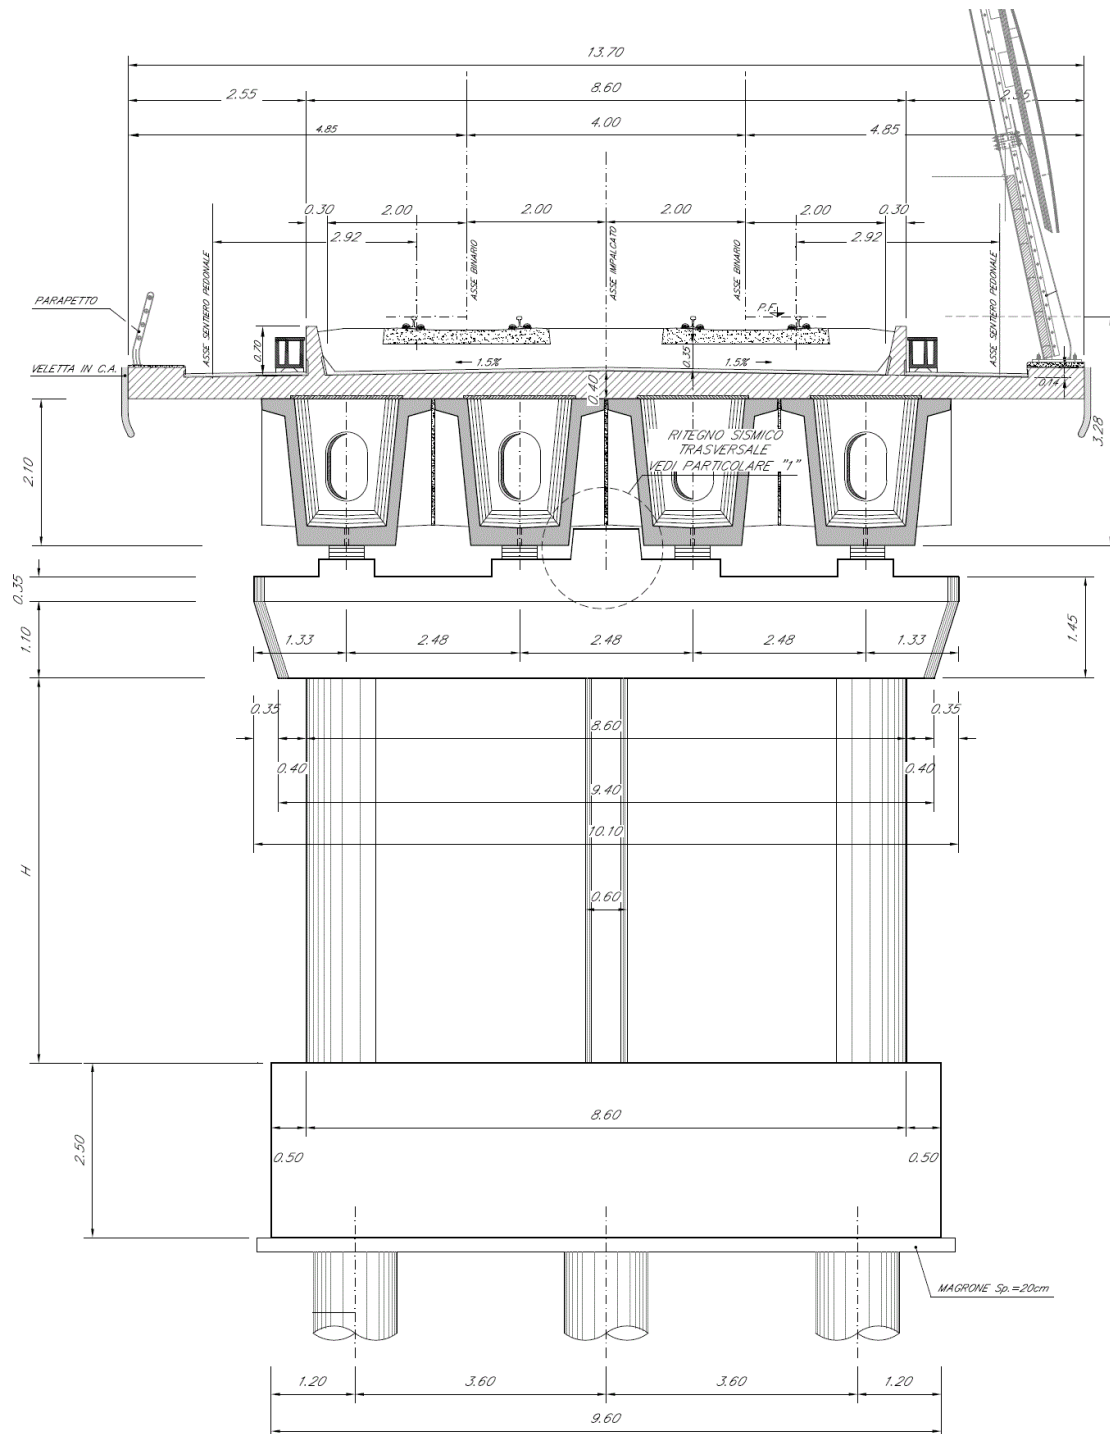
Pila, prospetto frontale – Impalcato in C.A.P. [m]
